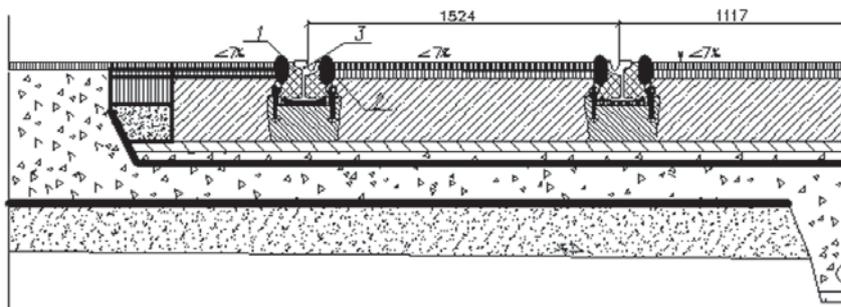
Конструкция трамвайных путей на монолитной железобетонной плите (поперечный разрез)
